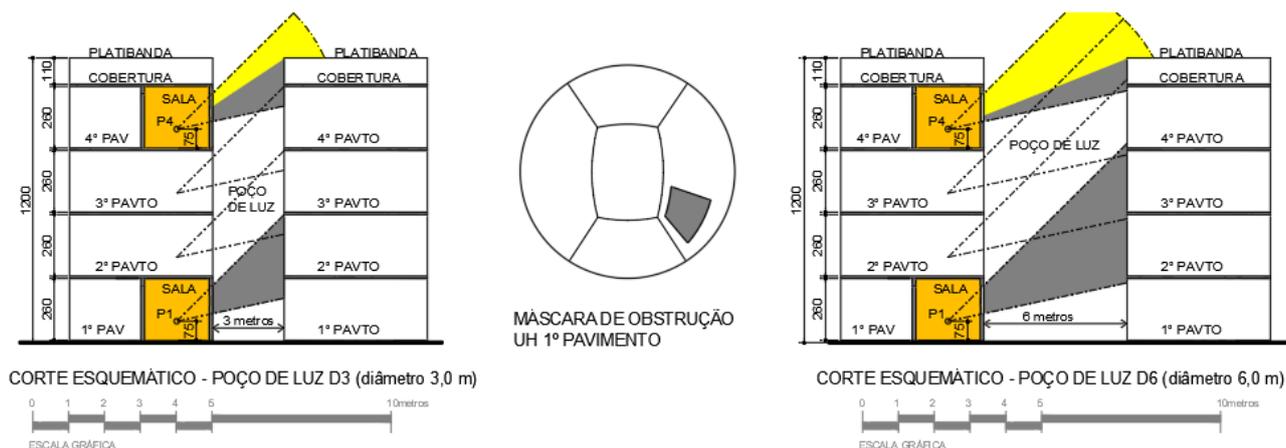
Máscara de obstrução do 1º pavimento e cortes esquemáticos para o ambiente (sala) voltado para o poço de luz com diâmetros (D) de 3 e 6 metros.
